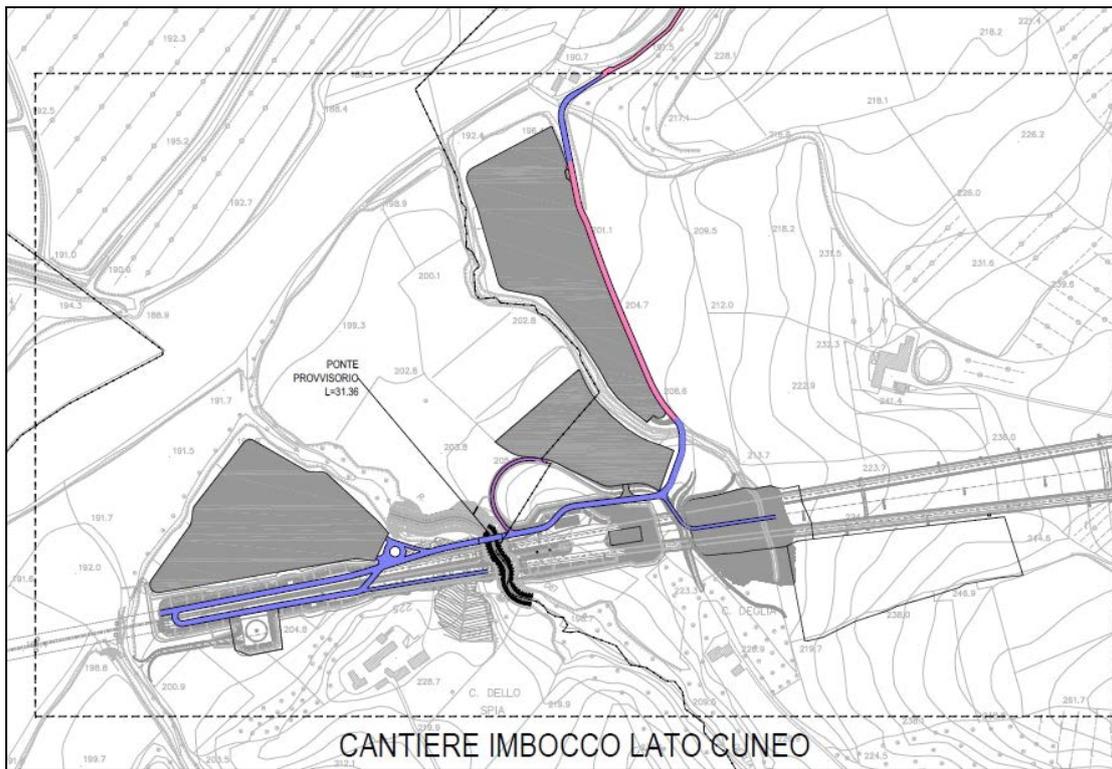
Localizzazione cantiere Imbocco Lato Cuneo
